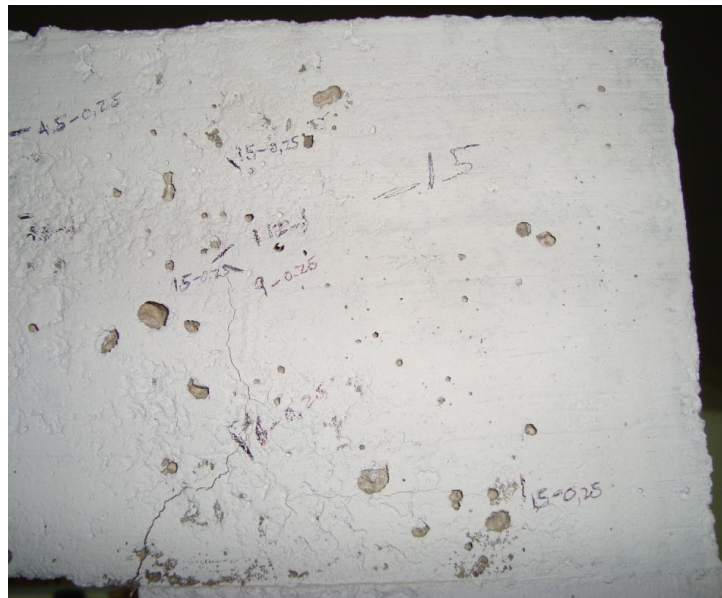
Fisuras generadas en el nudo 2
